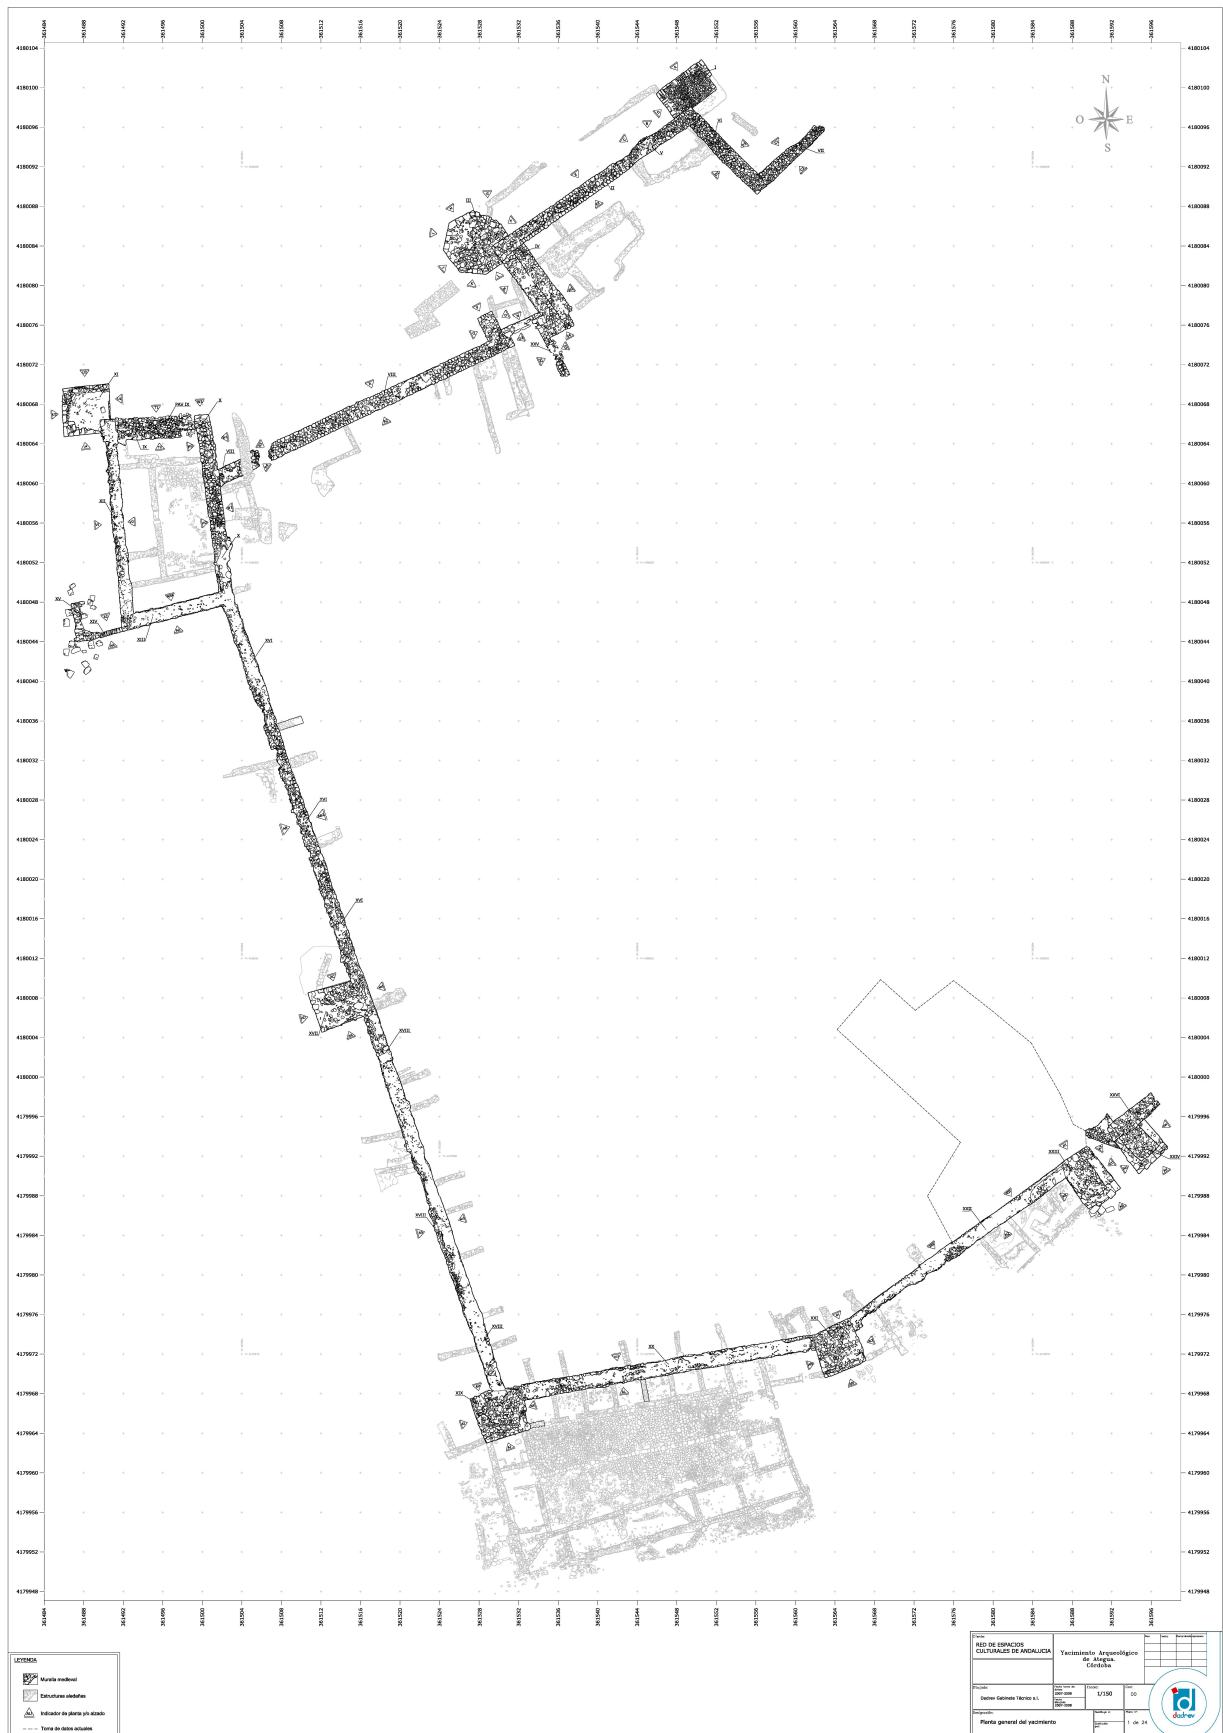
Planimetría de detalle de la muralla medieval levantada durante el bienio 2008-2009.
